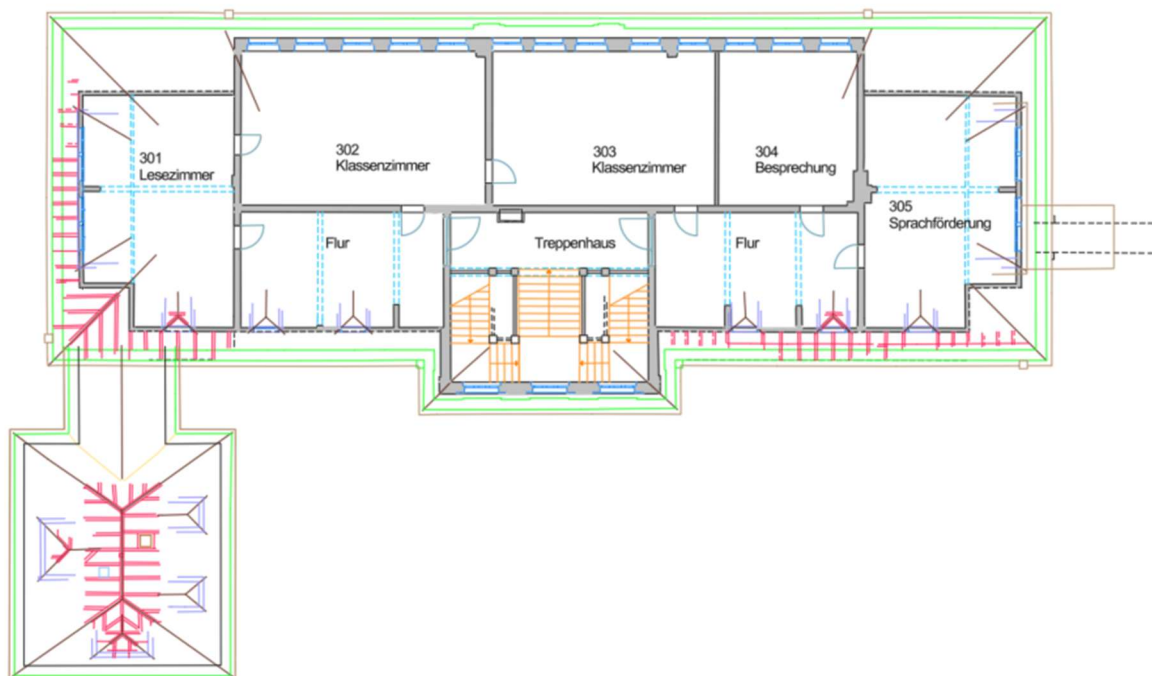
Grundriss Dachgeschoss Grundschule Neckargemünd (Altbau)
